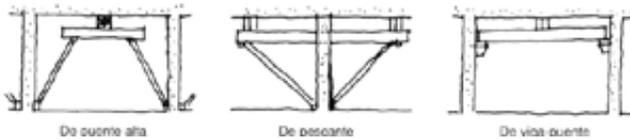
Apeo para forjado sin apoyo en piso inferior
